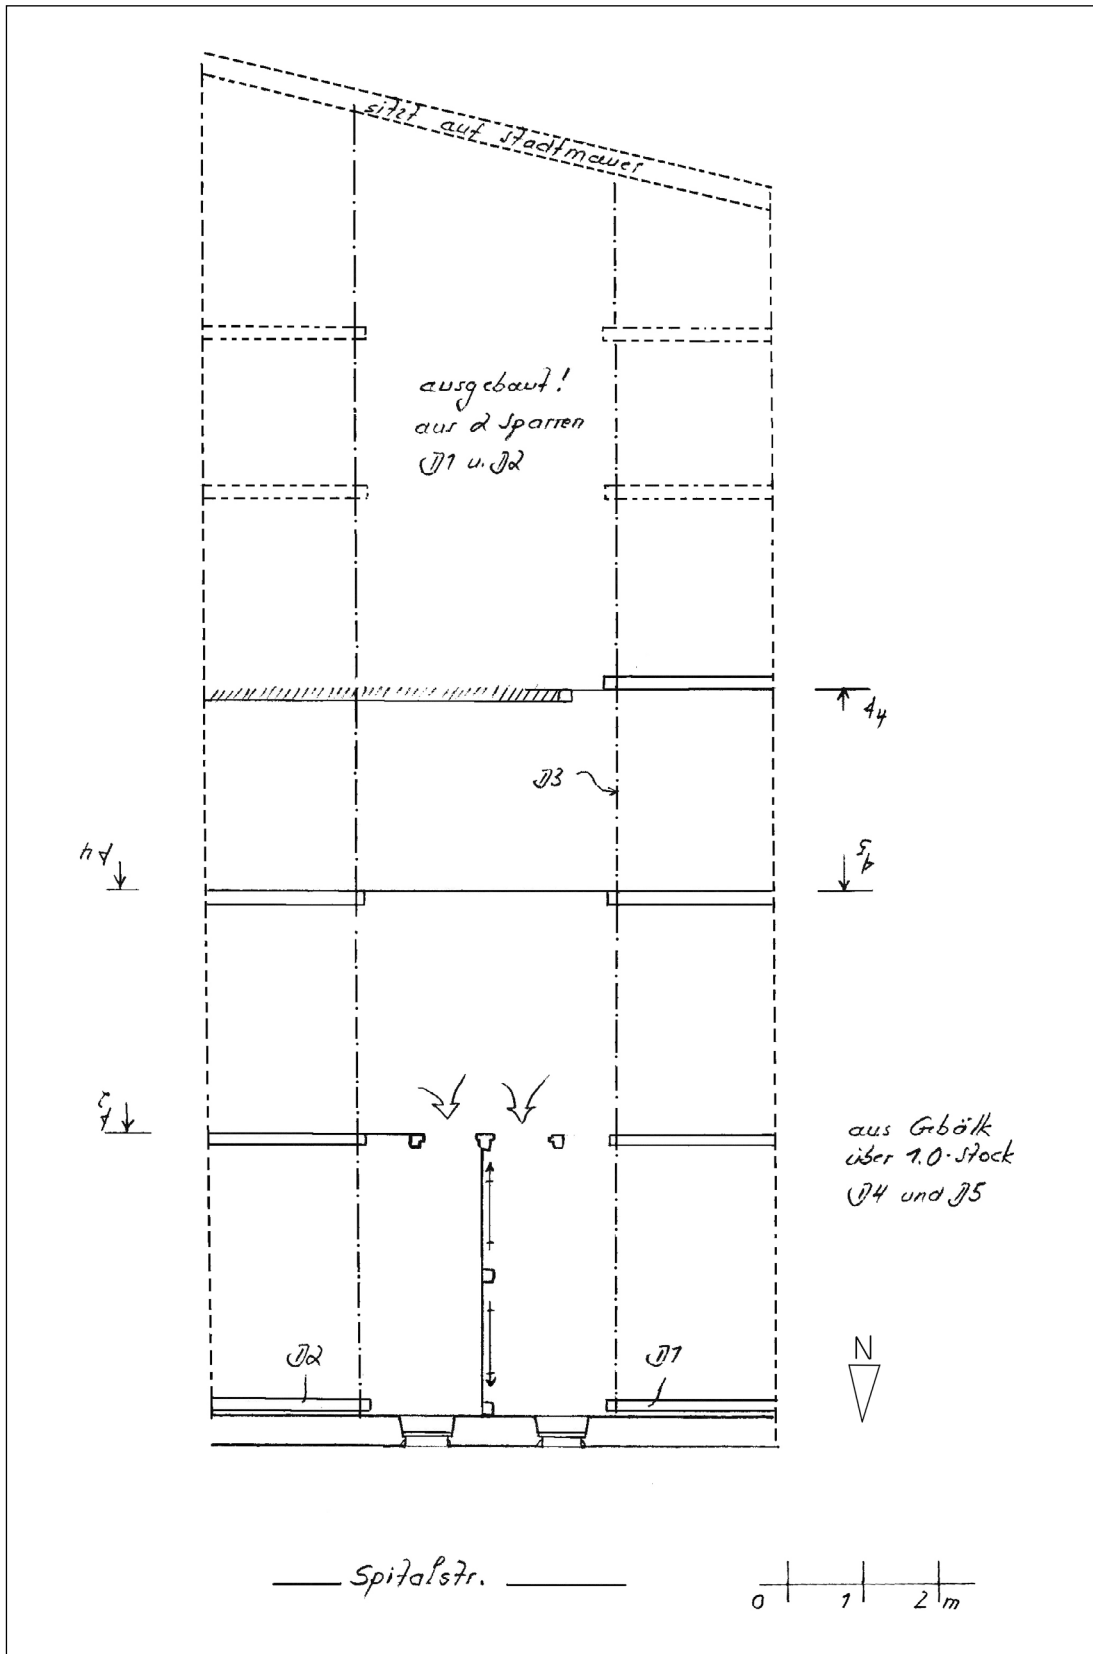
Spitalstraße 4, Grundriss 1. Dachgeschoss.
